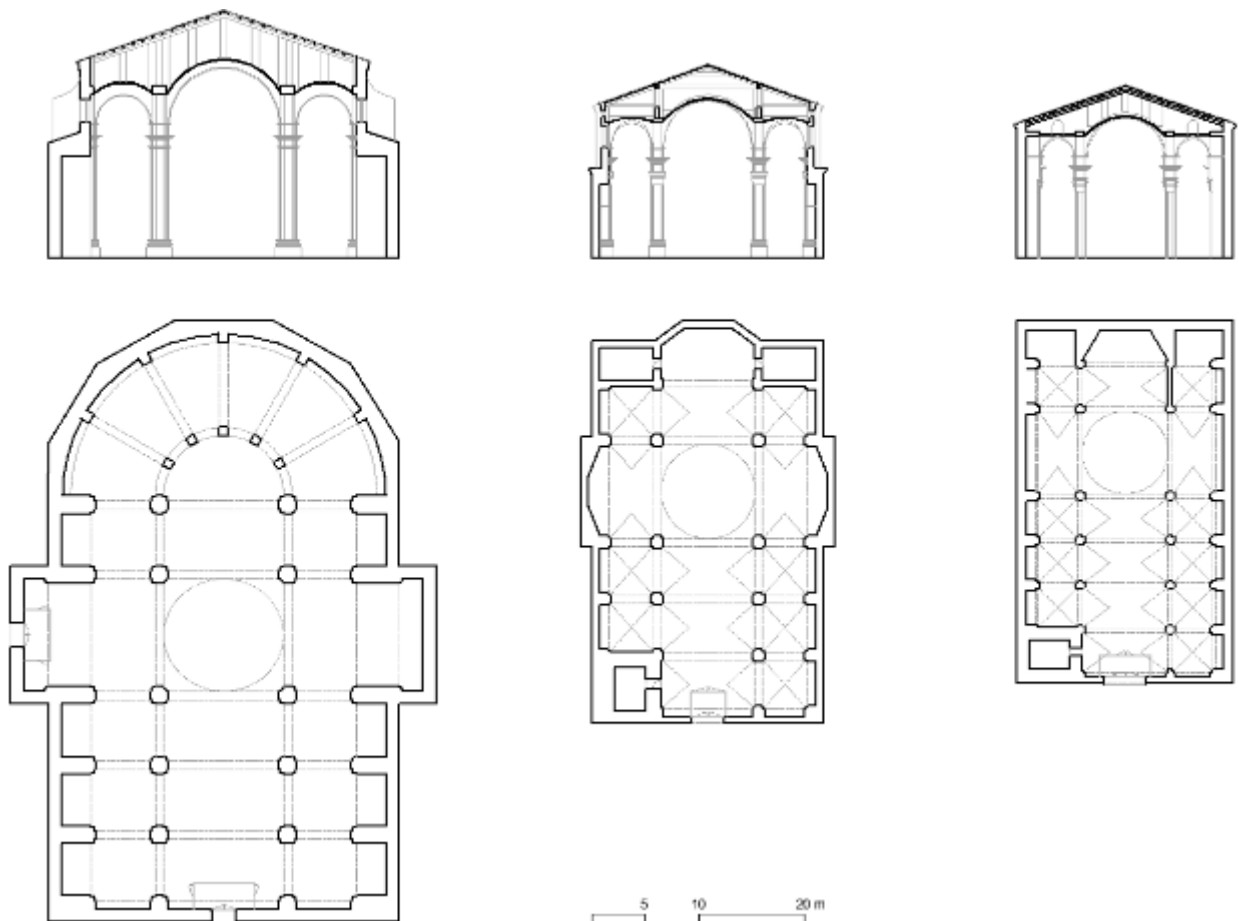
D'esquerra a dreta: Secció i planta de la Col·legiata d'Alcañiz, 1757, Fra Atanasio Aznar. Secció i planta de la Catedral de Lleida, 1781, Pedro Martín Cermeño.
